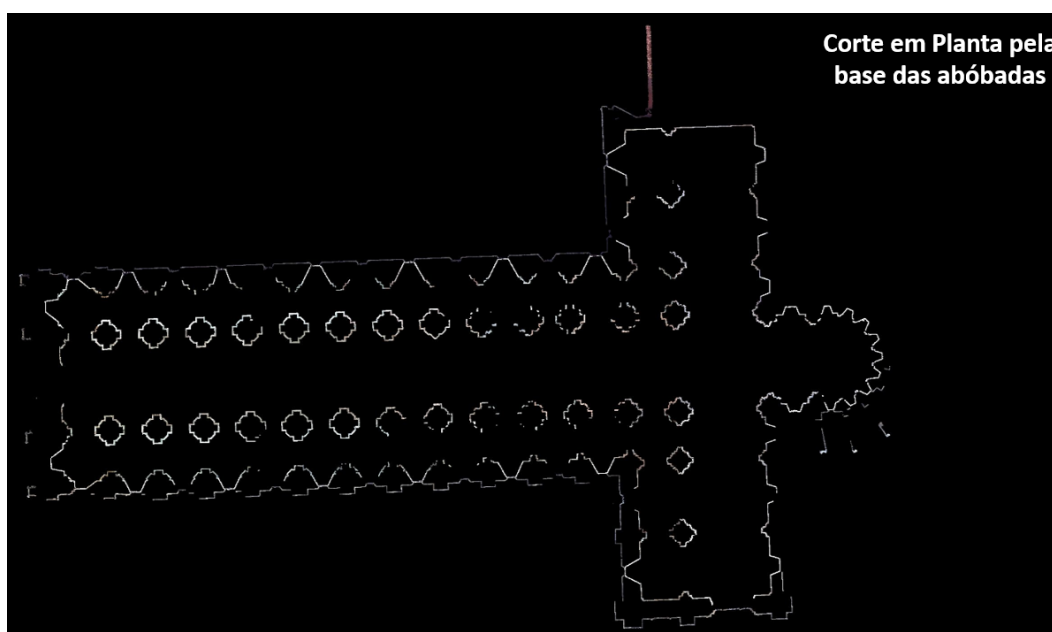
Corte em planta pela base das abóbadas da Igreja do Mosteiro de Alcobaça.
